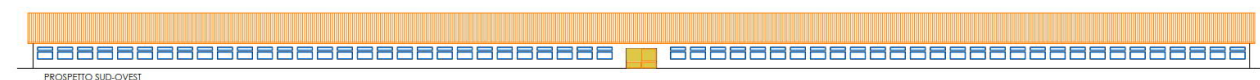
Prospetto Sud/Ovest porcilaia parto (estratto tavola 6)
